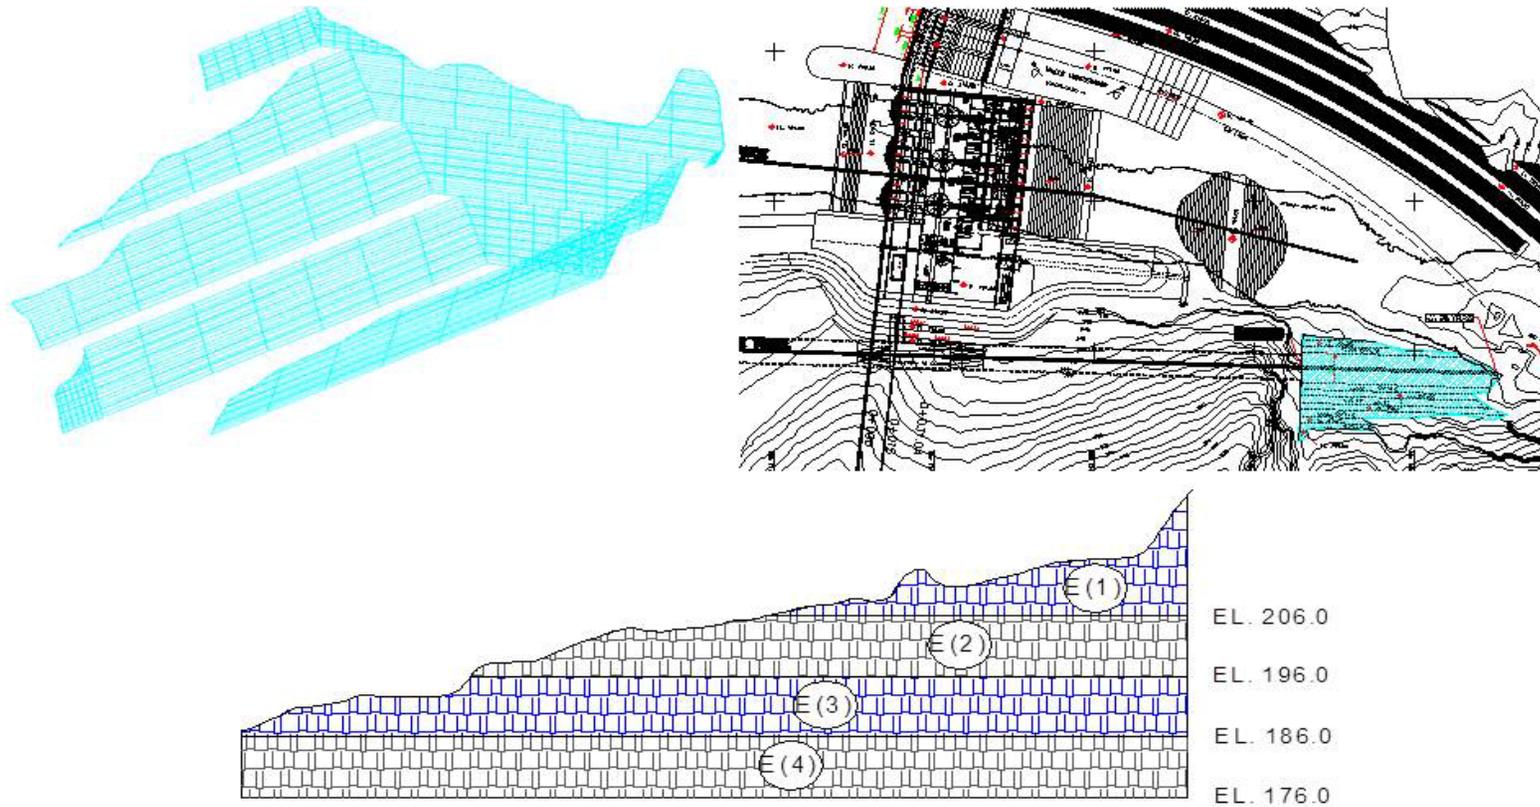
Portal de salida, vista 3D, vista en planta y corte longitudinal.
